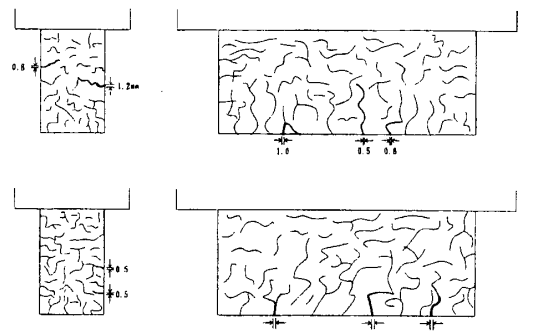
コンクリート試験体加熱後の亀裂発生状況
